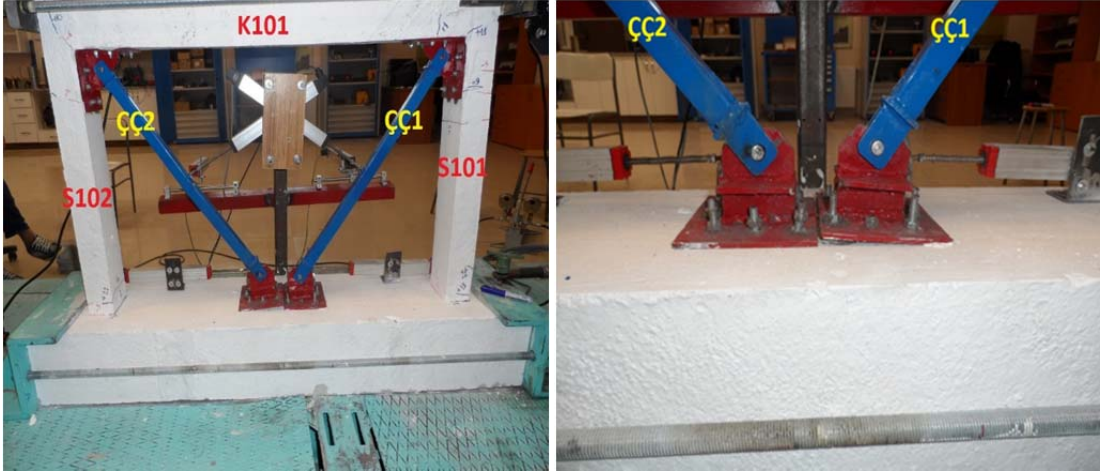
Kolon kiriş birleşim bölgesinde ankraj sıyrılması
